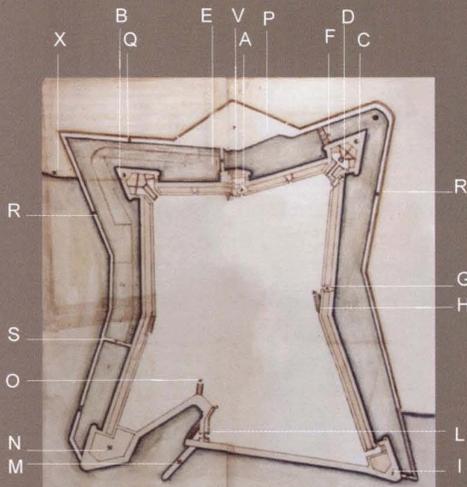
Planta de Mazagão de 1611 (parcial) Arquivos Nacionais / Torre do Tombo
